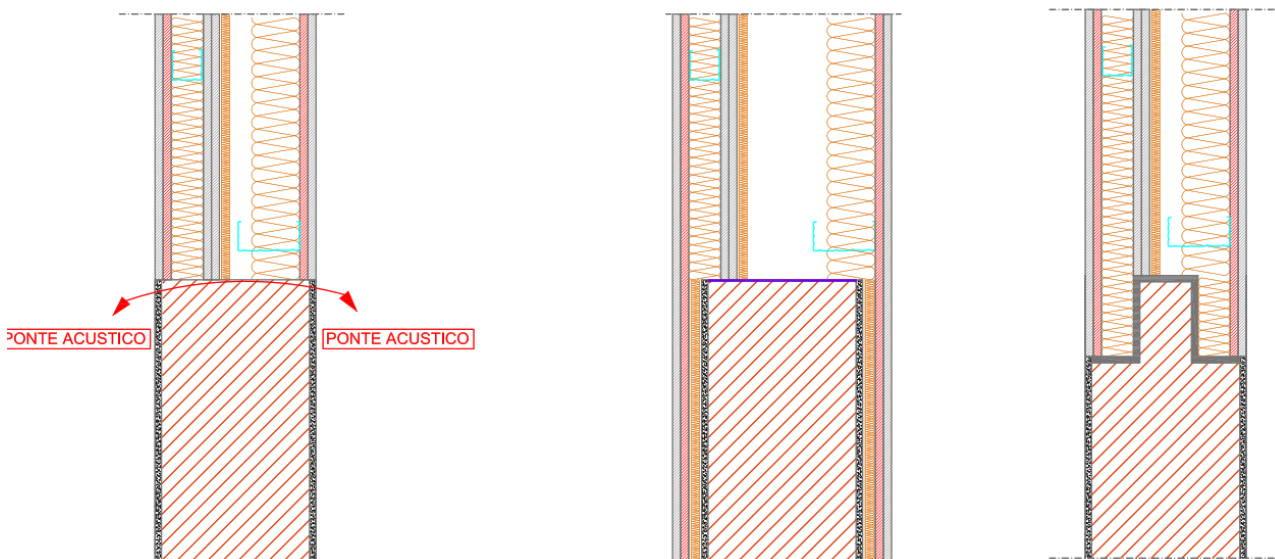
Sezione orizzontale. Trattamento del ponte acustico tra strutture verticali (giunto tra sistemi in ca o muratura e sistemi a secco)
